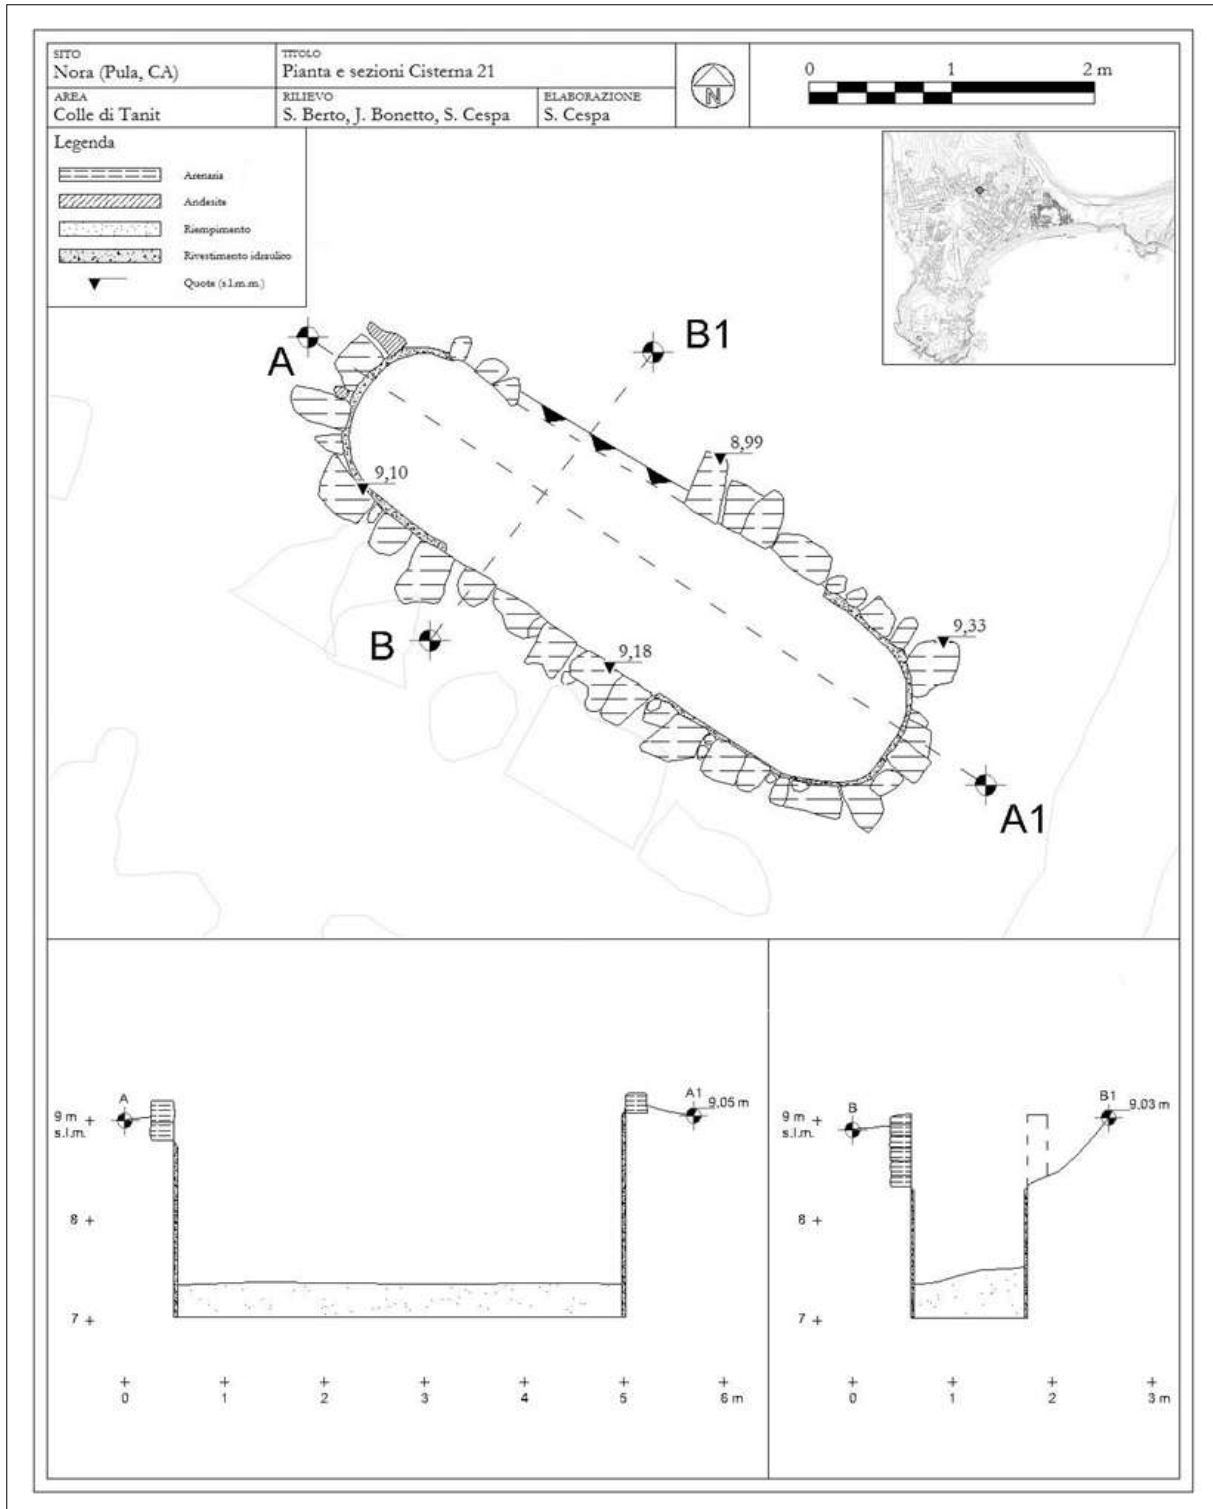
Pianta e sezioni della cisterna 21 (elaborazione dell'autore).
